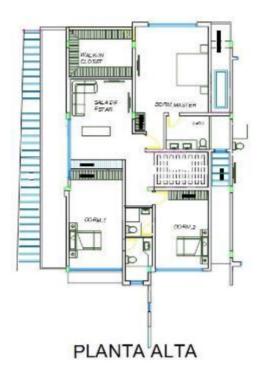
Casa 9- planta alta Elaborado por: Carolina Calupiña M
